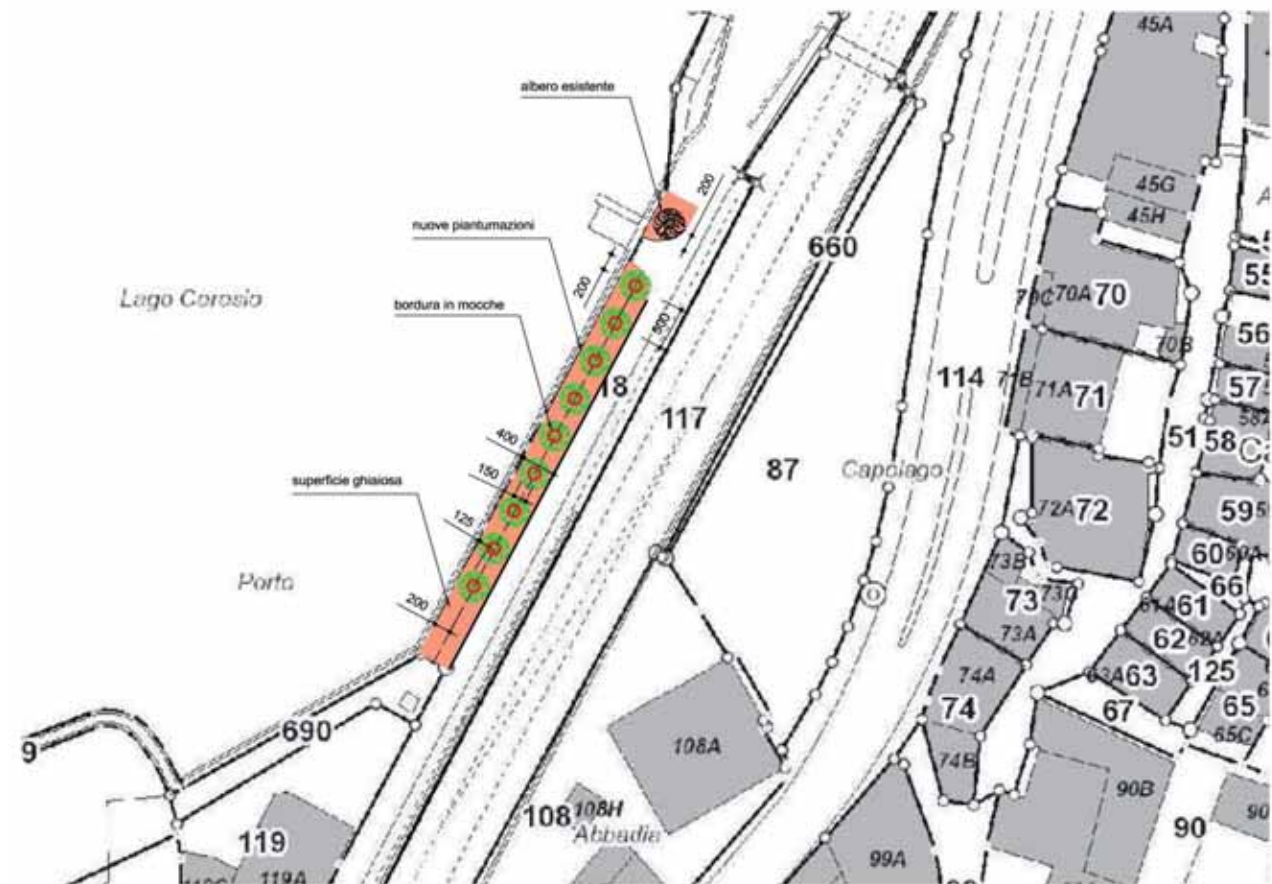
Planimetria degli interventi Fonte: SIT-TI
